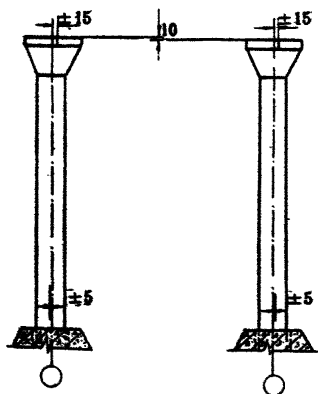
Рис. II. Допускаемые отклонения при монтаже колонн подсилосного этажа
